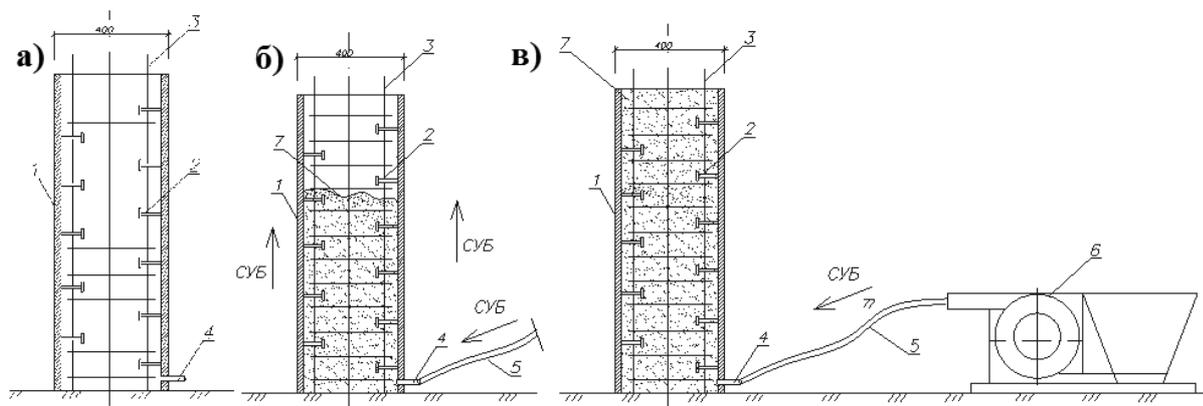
Бетонирование сталежелезобетонной колонны самоуплотняющимся бетоном:
